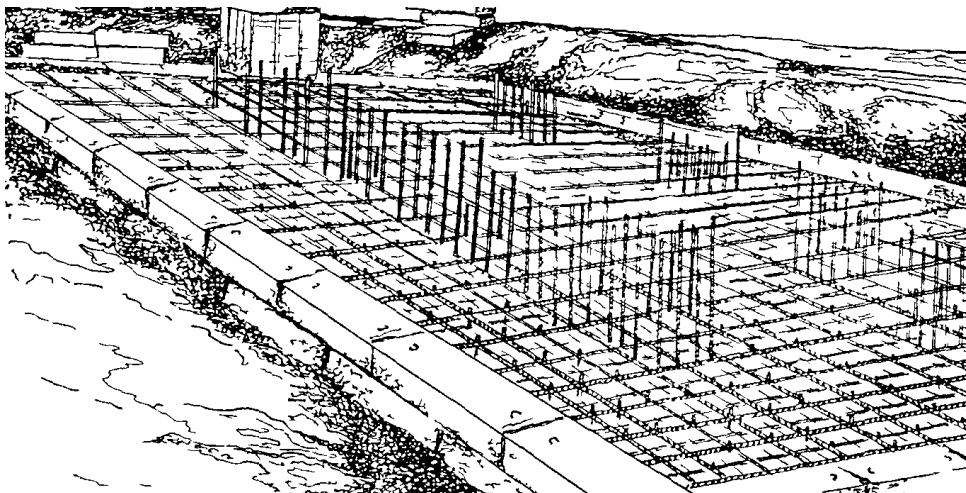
Устройство монолитной фундаментной плиты с опалубкой из сборных железобетонных блоков
